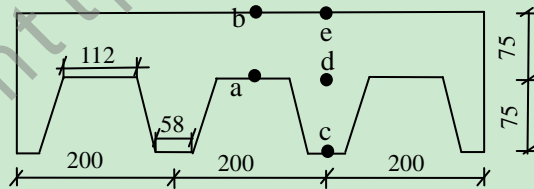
钢-混凝土组合楼板界面温度测点示意图
